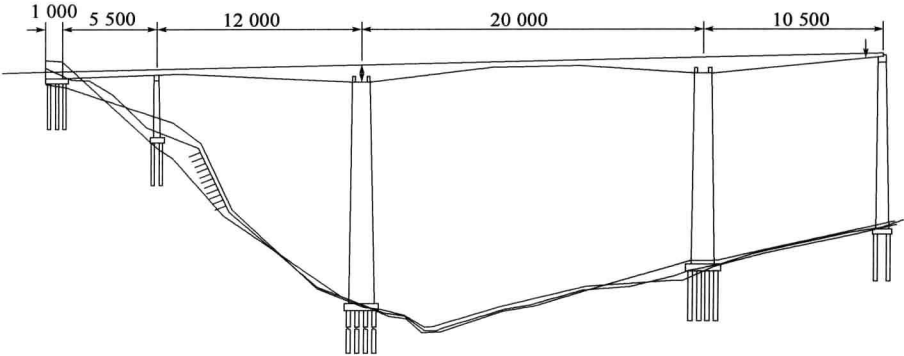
黑石沟特大桥主桥立面图(尺寸单位:cm)
